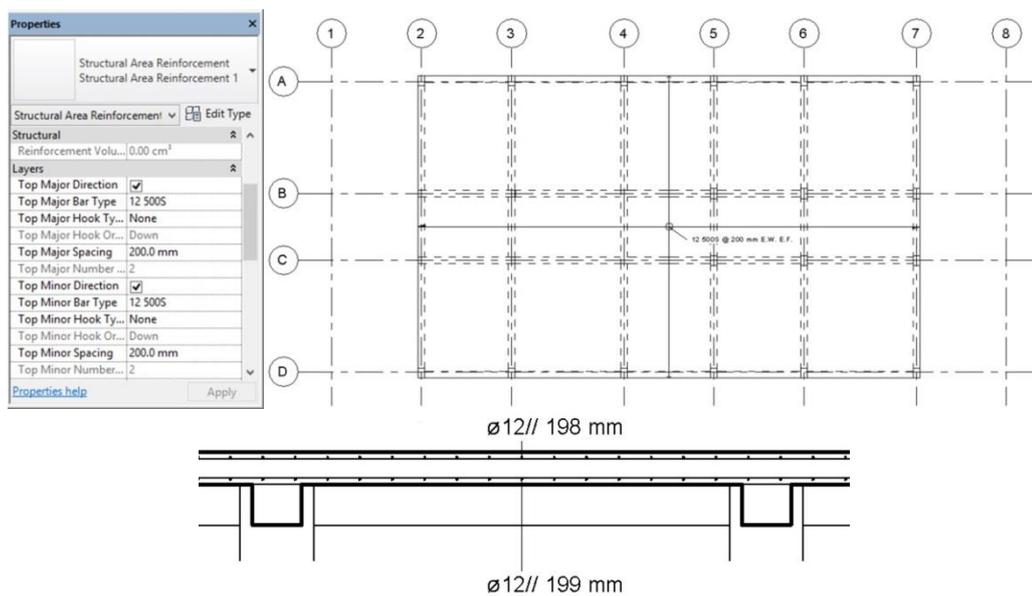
Pormenorização de armaduras em laje e detalhe de representação em corte [4].
